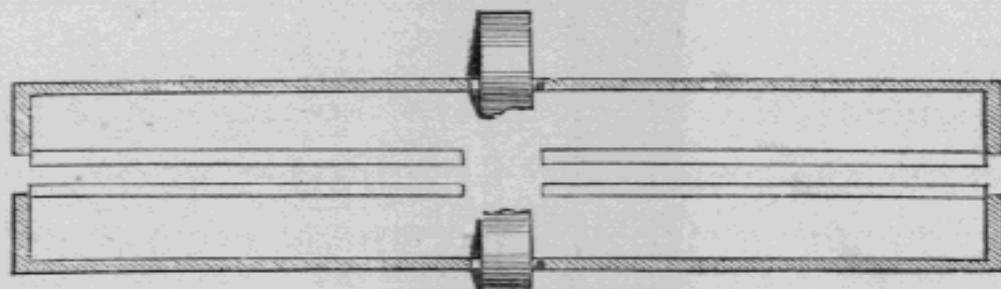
Plan de la bergerie modèle à deux rangs longitudinaux, en pierres et tuiles plates.
